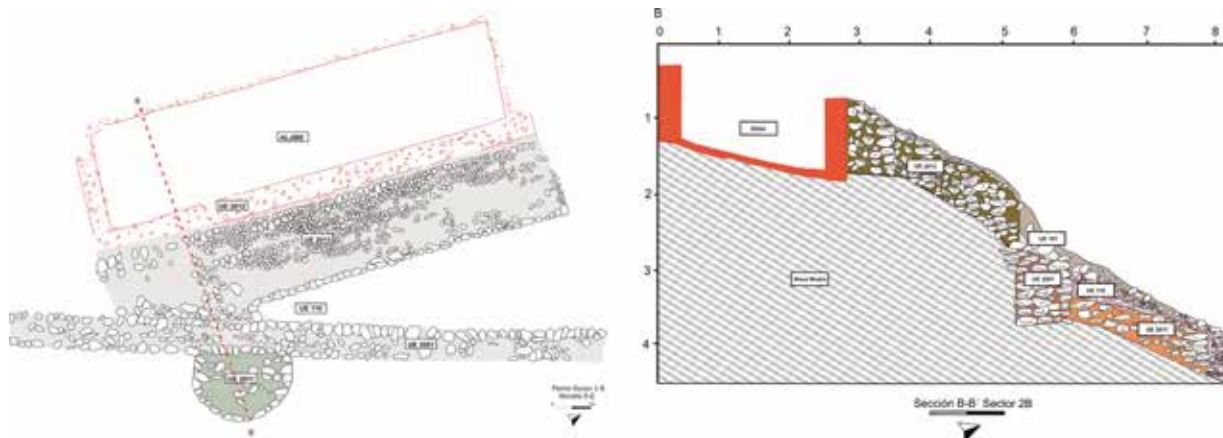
Planta y sección del aljibe, muro transversal y contrafuerte II.
